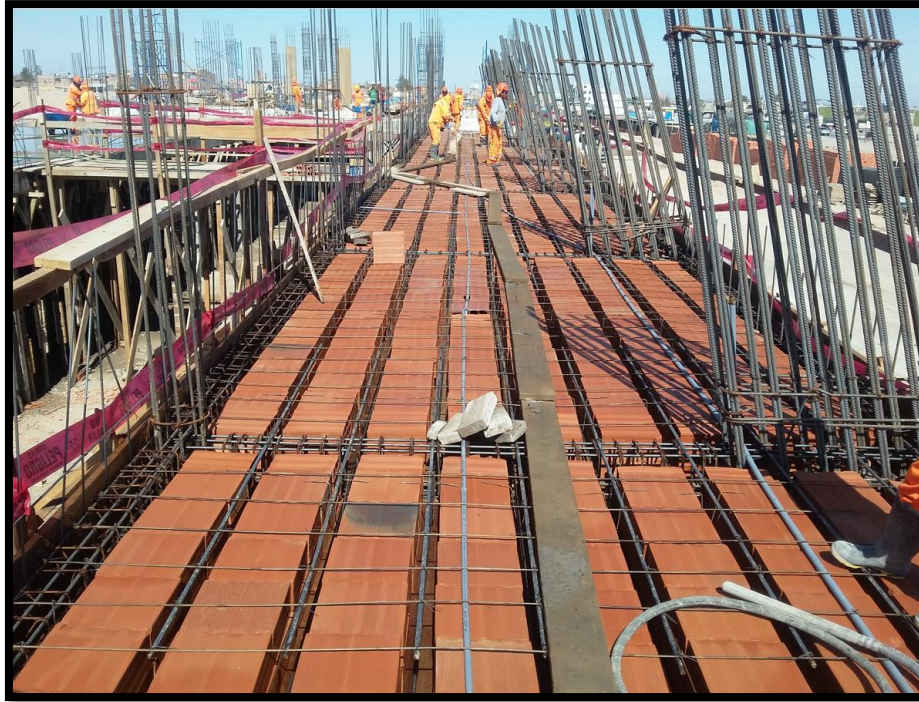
Colocación de acero en viguetas según planos de estructura de techo
